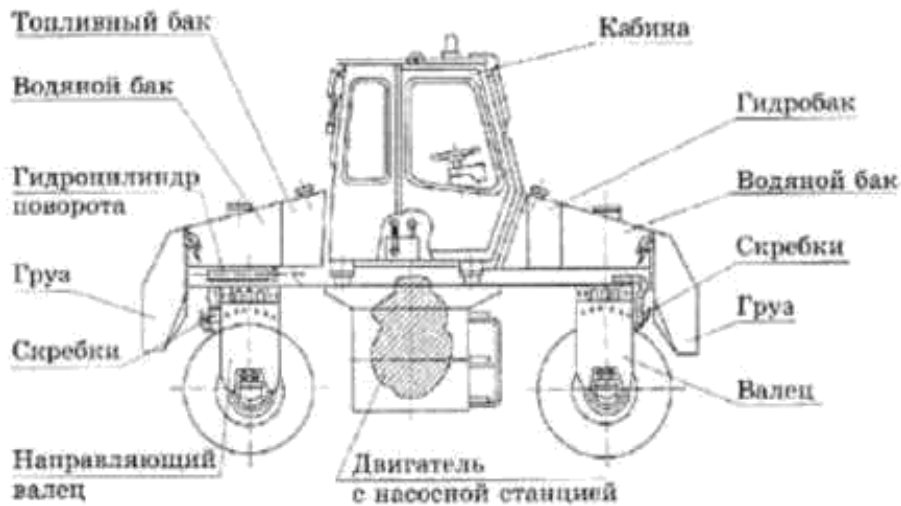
Компоновка пневмоколесного статического катка
